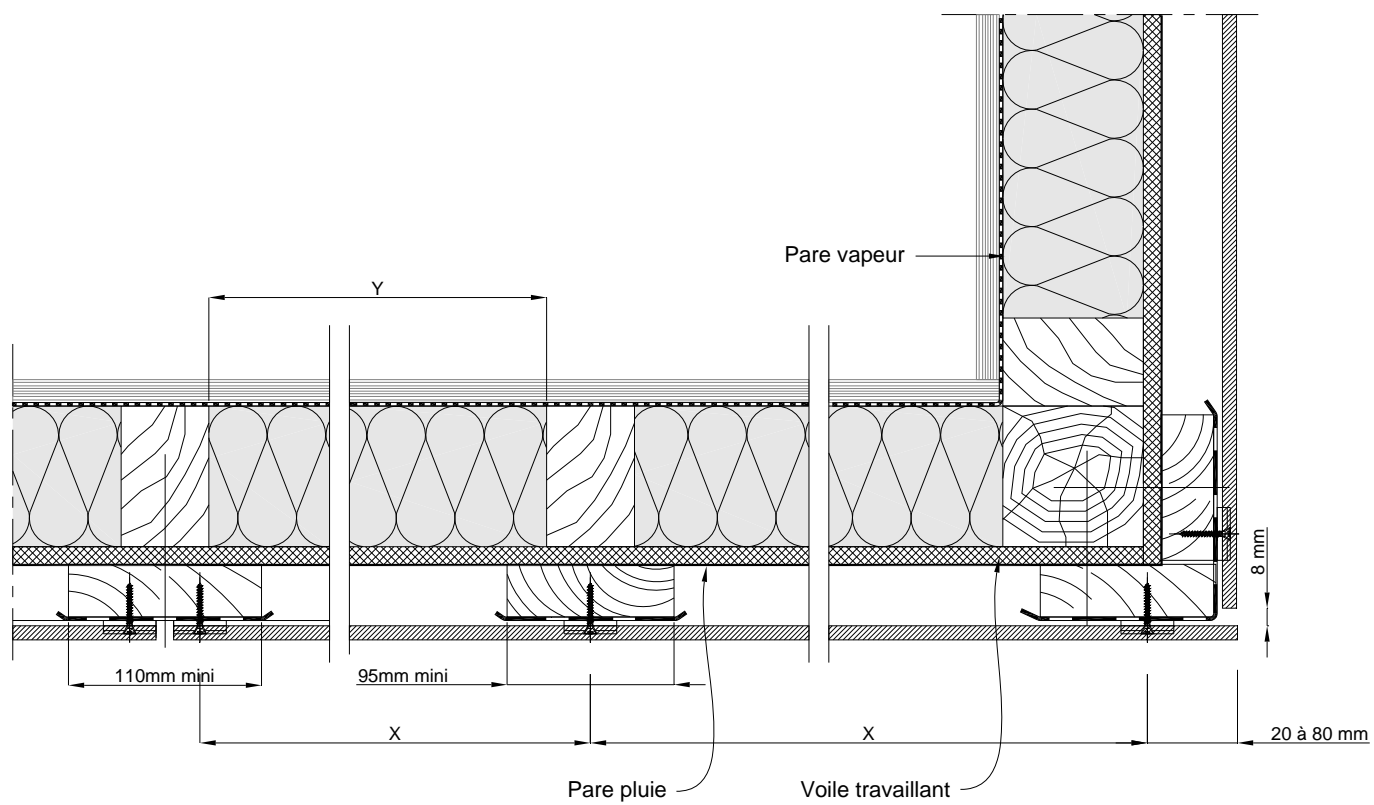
Pose horizontale - Coupe horizontale sur COB
